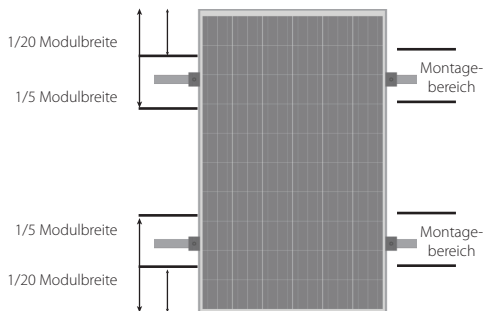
Mechanische Dimensionen, wenn die Module vertikal ausgerichtet mit der Klemmbefestigungsmethode installiert werden
